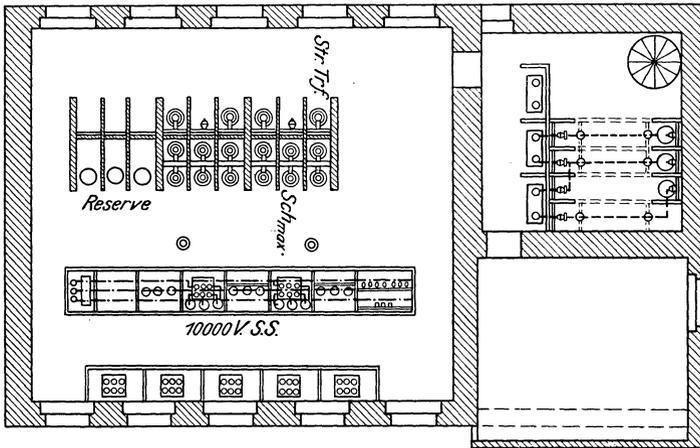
Grundriß des I. Stockwerkes des Hauptgebäudes mit der 10 000-Volt-Verteilungsanlage.
